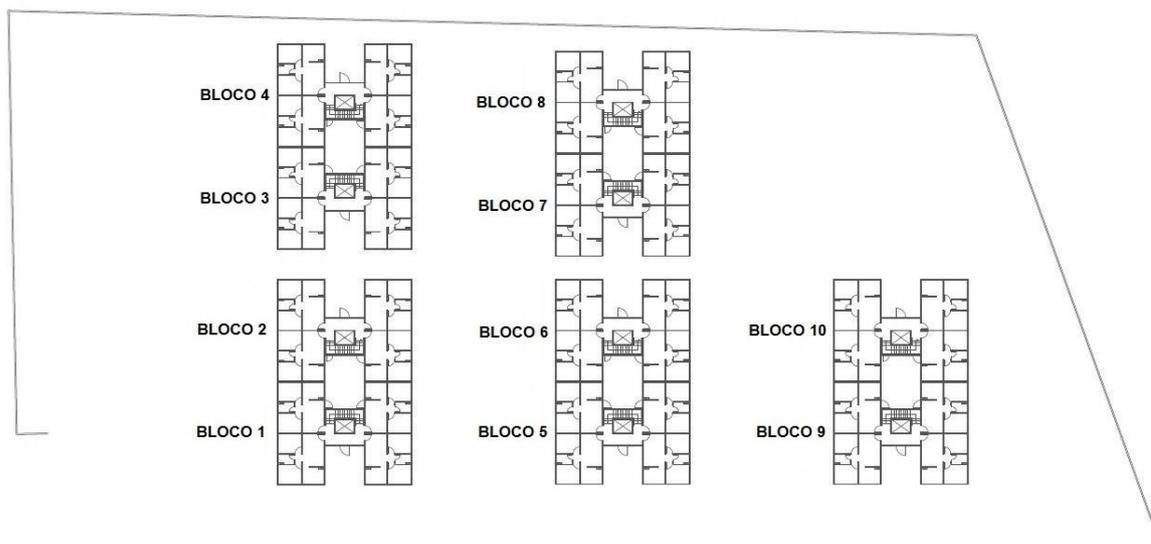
Layout* do canteiro de obra do empreendimento (Elaborado pelo autor)
